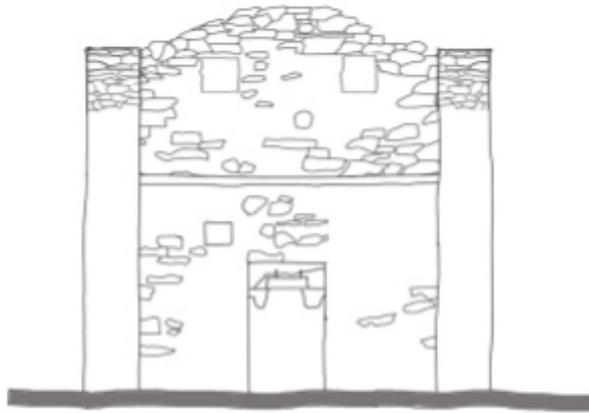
Andriani Mario. prospetto nord-ovest sc. 1:100
